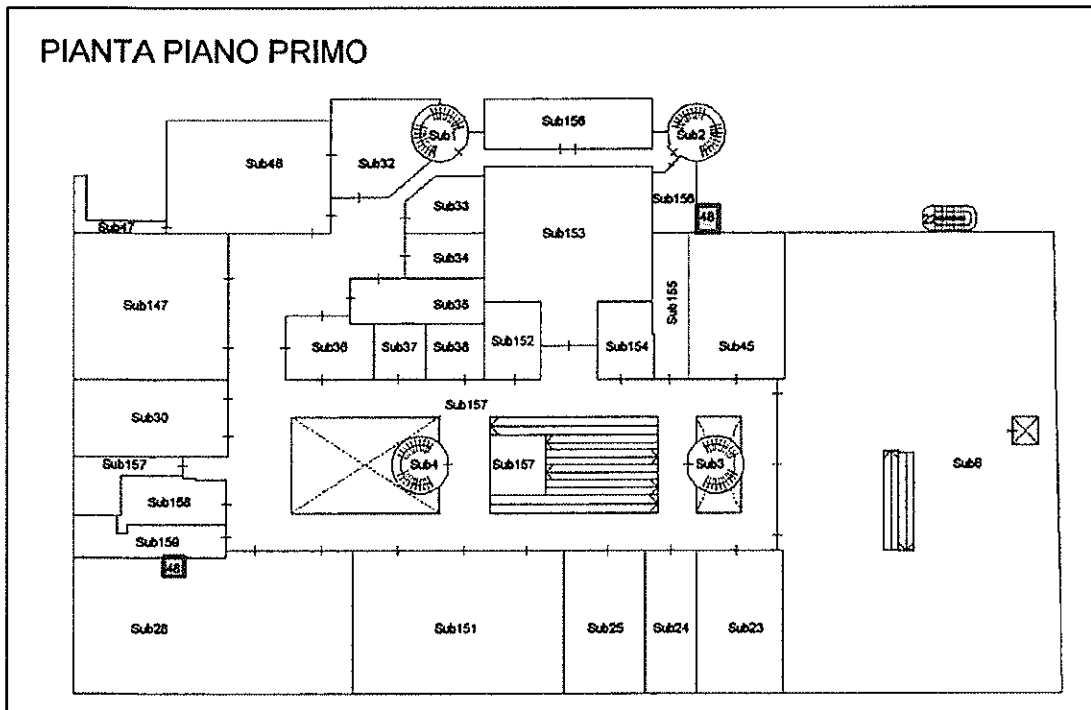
Elaborato planimetrico piano 1. Individuazione sub 48 (porzione).
